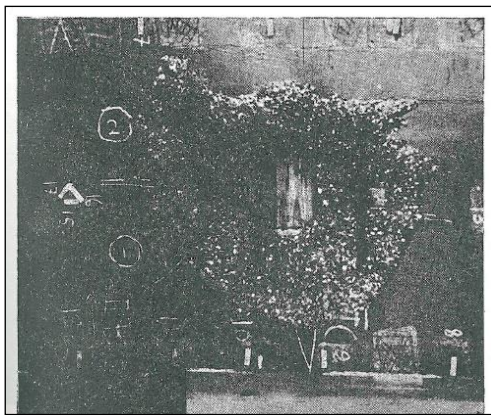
Photo de la rupture de la dalle V (en face inférieure)
